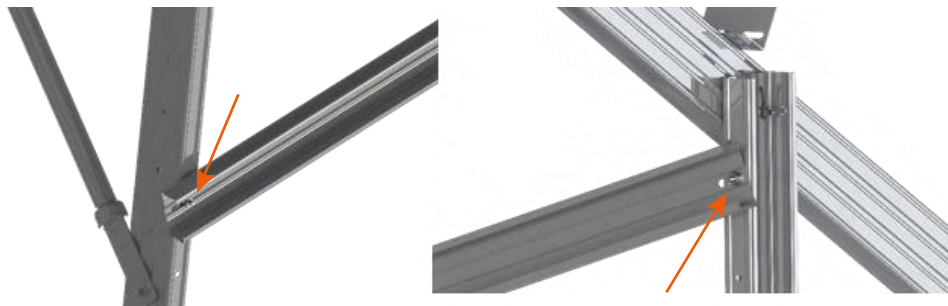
Furos superiores nas laterais dos pilares para a fixação do contraventamento
